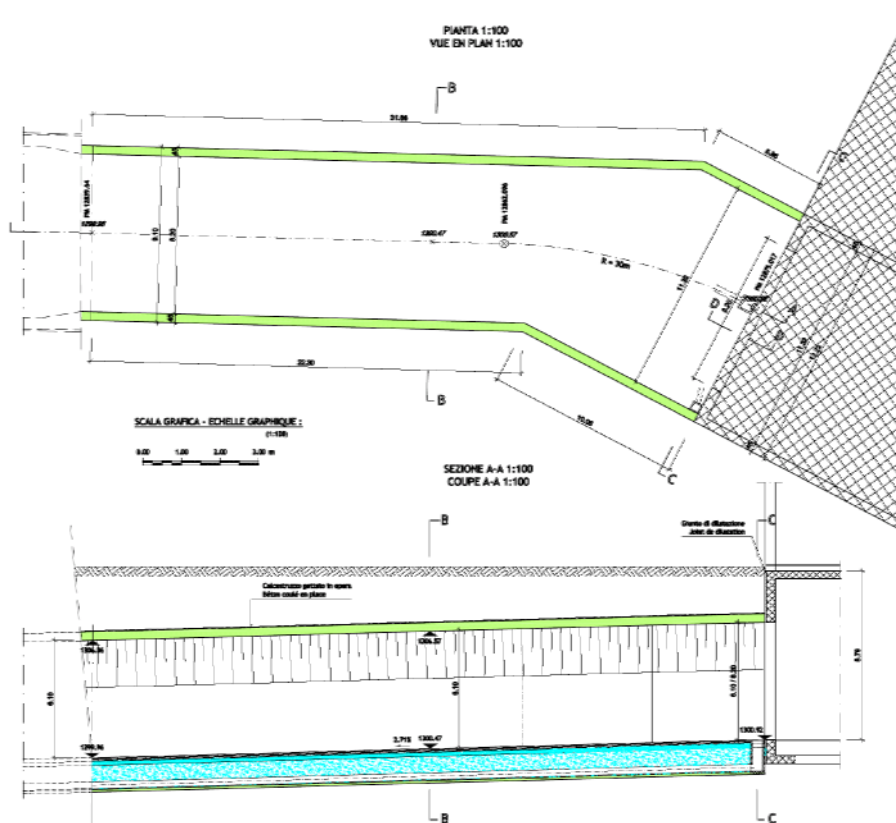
Plan et coupe longitudinale de la tranchée couverte côté Italie
